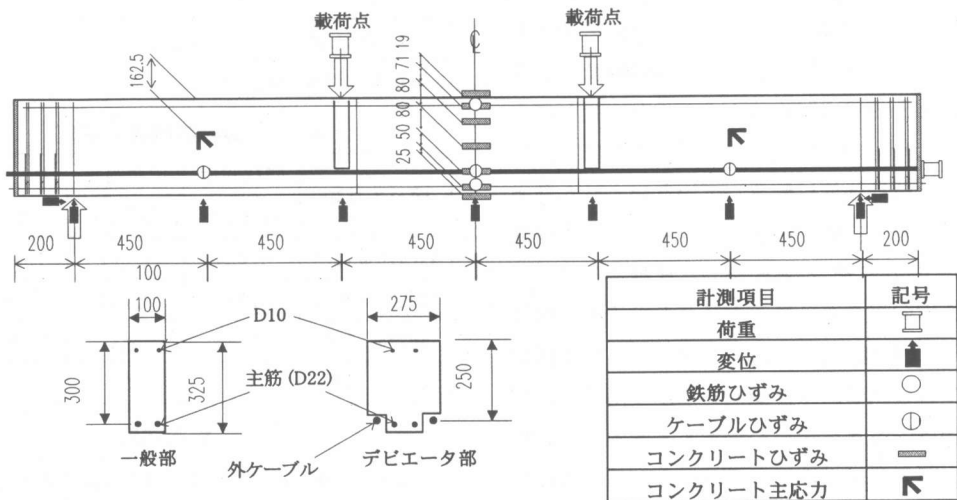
試験体の諸元, 荷重の載荷方法および計測方法 (単位: mm)
